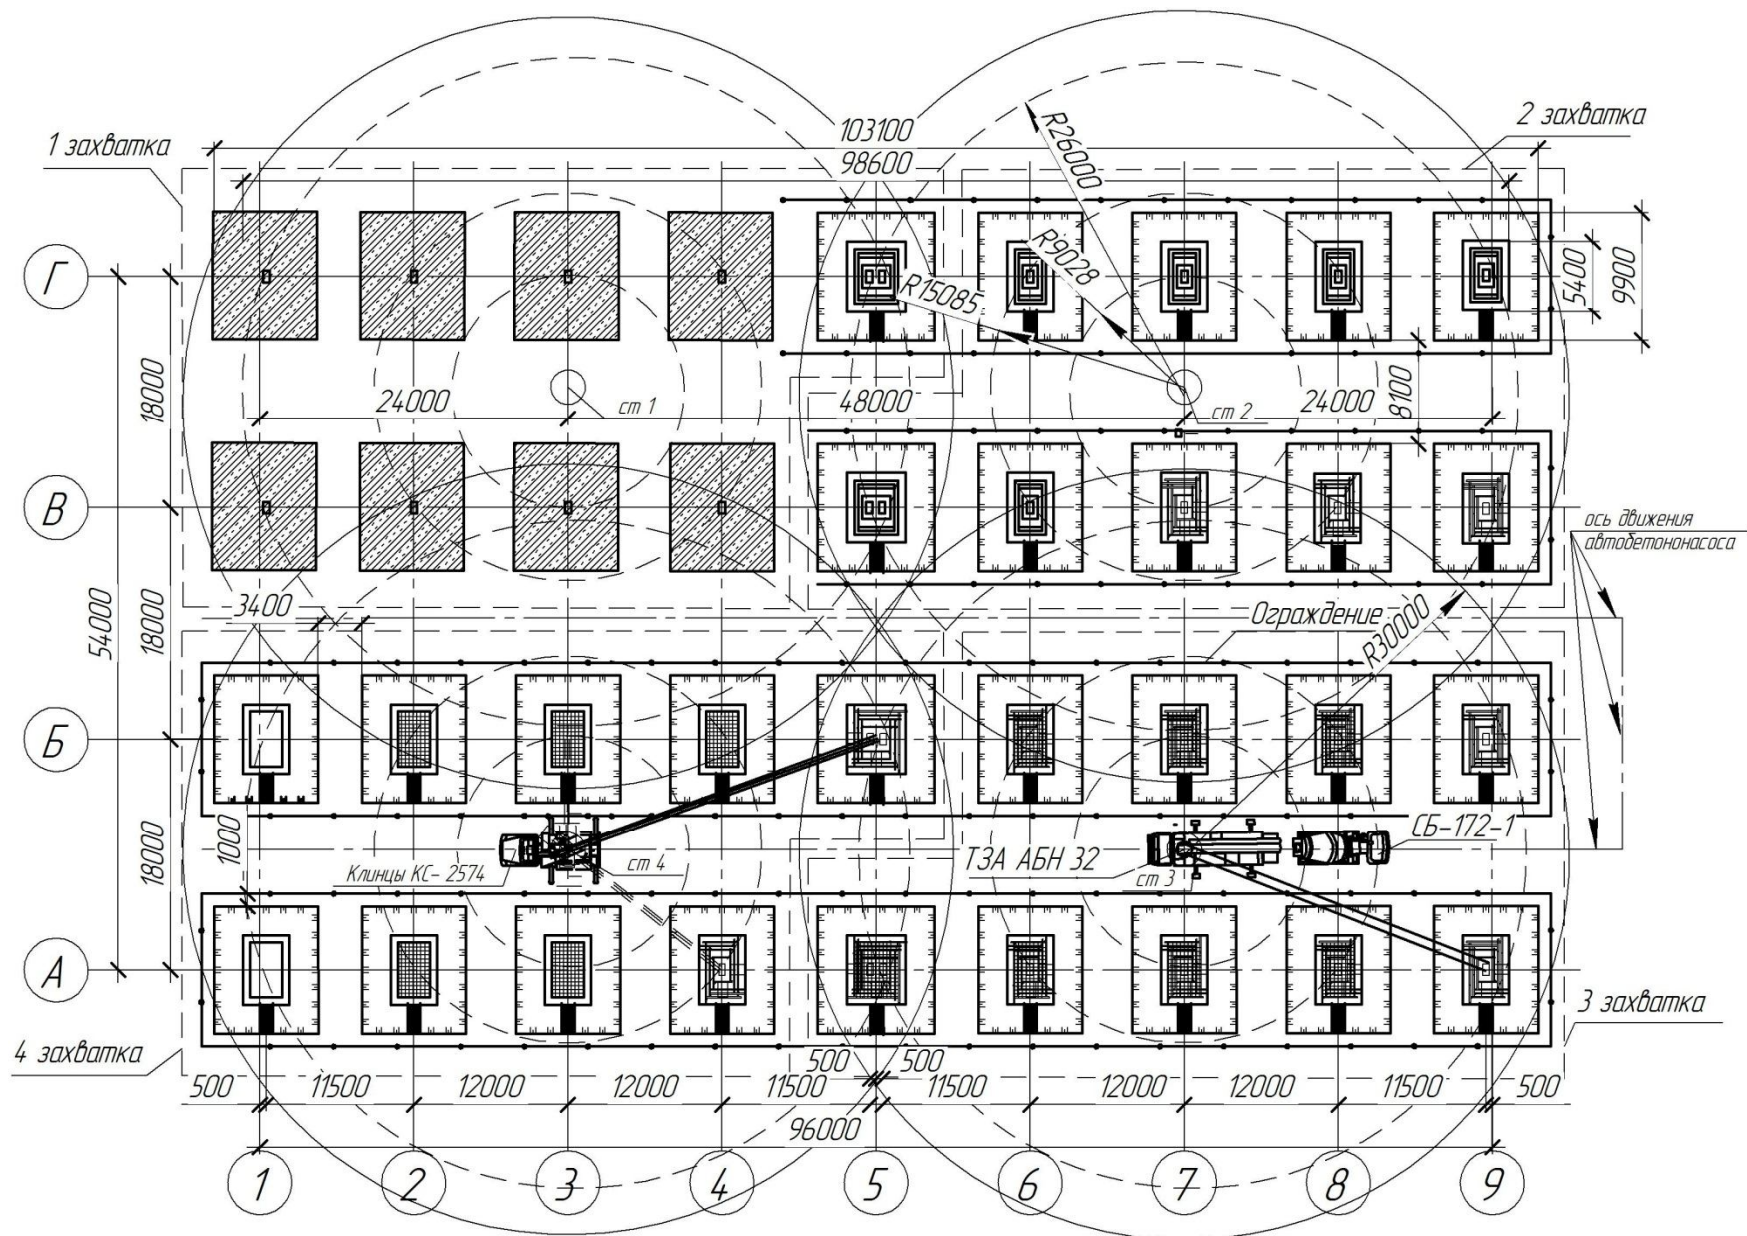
Общая технологическая схема бетонирования фундаментов (автобетононасосом)
